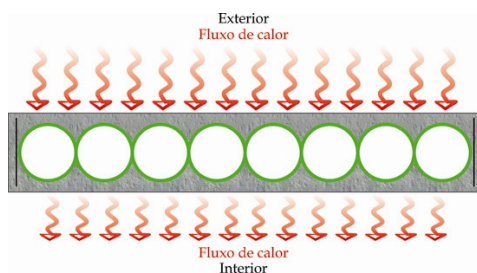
Planta do painel de parede com o sentido do fluxo de calor na situação de verão.
